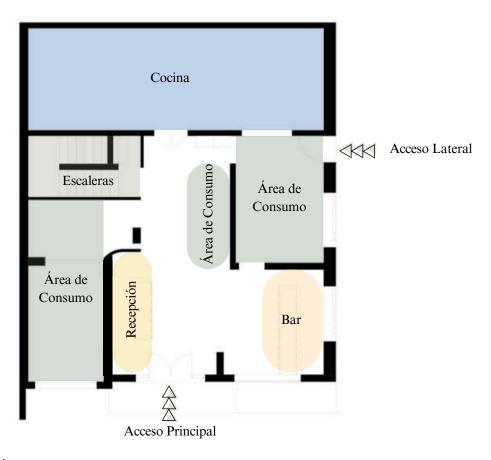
Estado Actual Planta Baja. Fuente: Elaboración propia.
